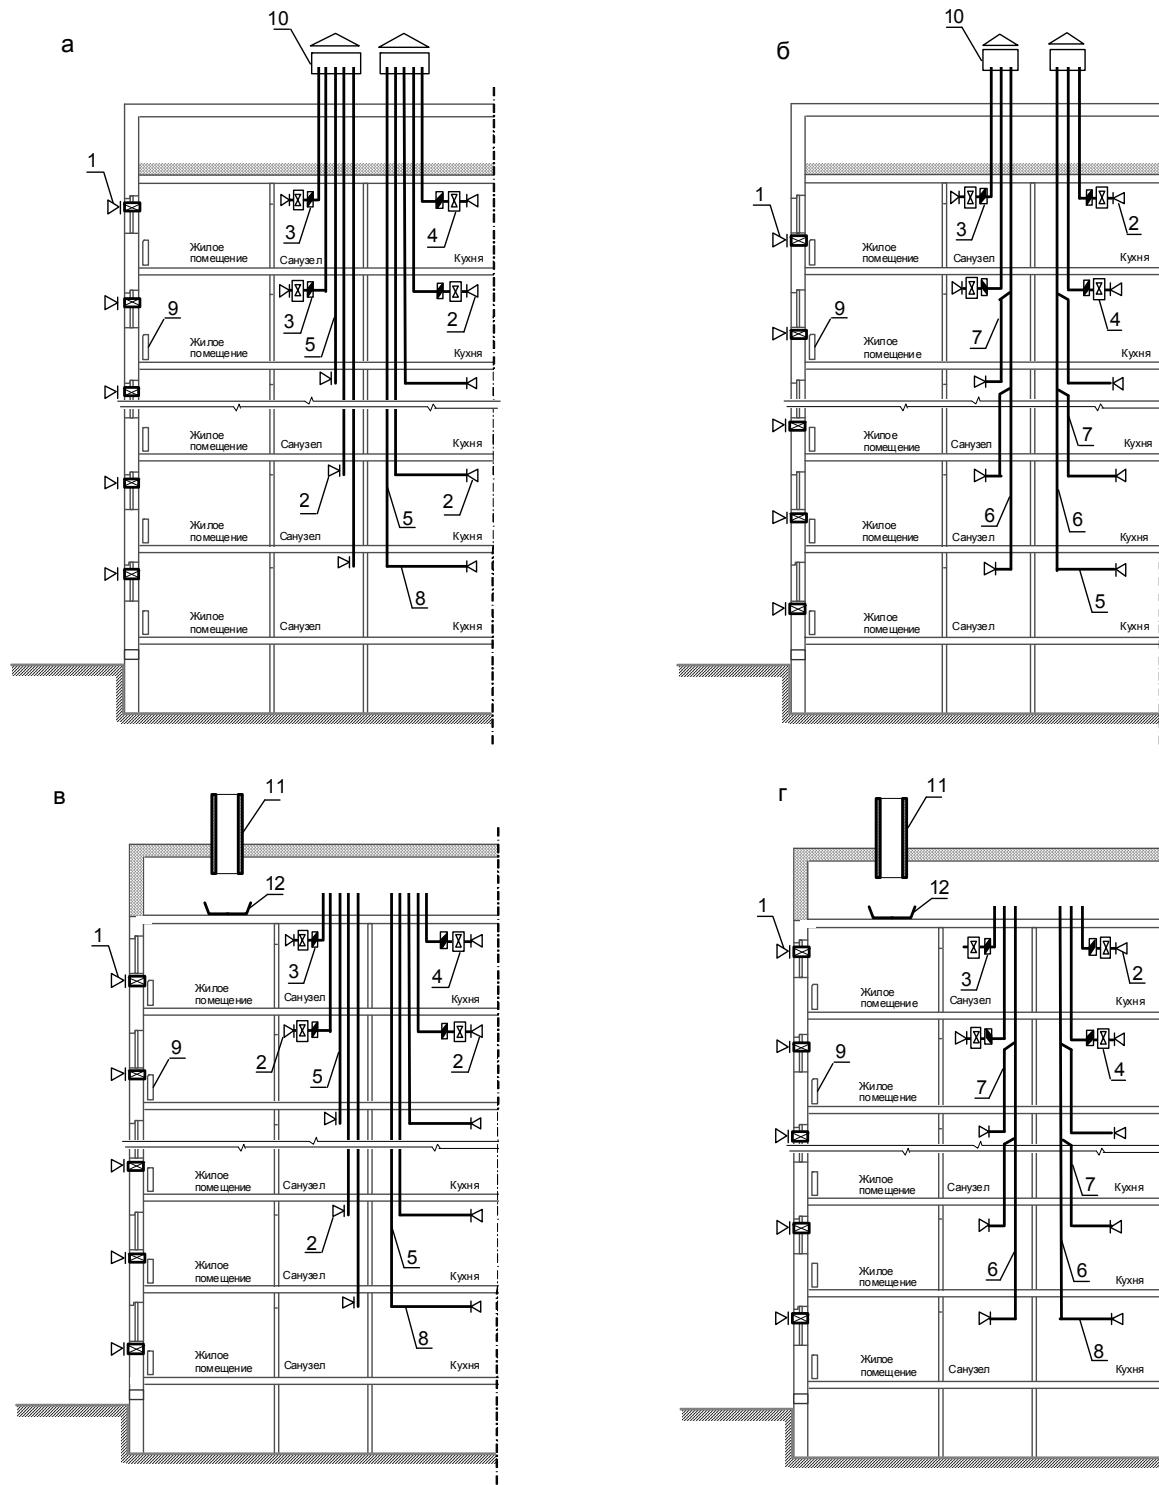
Схемы систем вентиляции жилых зданий с естественным побуждением движения воздуха: а, б – с холодным чердаком; в, г – с теплым чердаком: 1 – приточное вентиляционное устройство (оконный или стеновой вентиляционный клапан с регулируемым открыванием); 2 – вытяжная вентиляционная решетка; 3 – обратный клапан; 4 – вытяжной вентилятор (по расчету на верхних этажах); 5 – вертикальный вентиляционный канал; 6 – сборный вентиляционный канал; 7 – канал-спутник; 8 – горизонтальный вентиляционный канал (воздуховод); 9 – прибор системы отопления; 10 – дефлектор; 11 – вытяжная вентиляционная шахта; 12 – поддон
